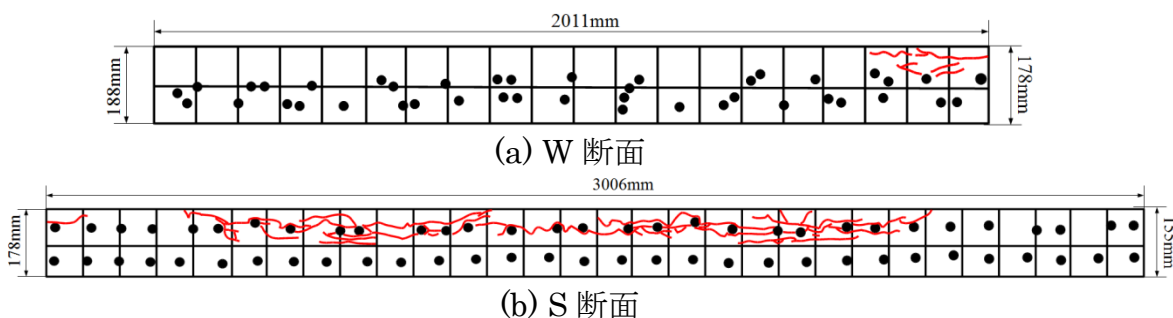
取替え床版切断面ひび割れ発生状況(載荷試験前)
